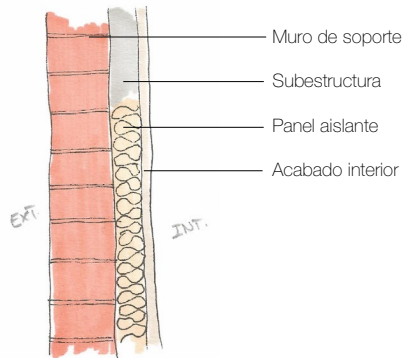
Detalle genérico en sección del sistema de trasdosado interior (autoría propia).
